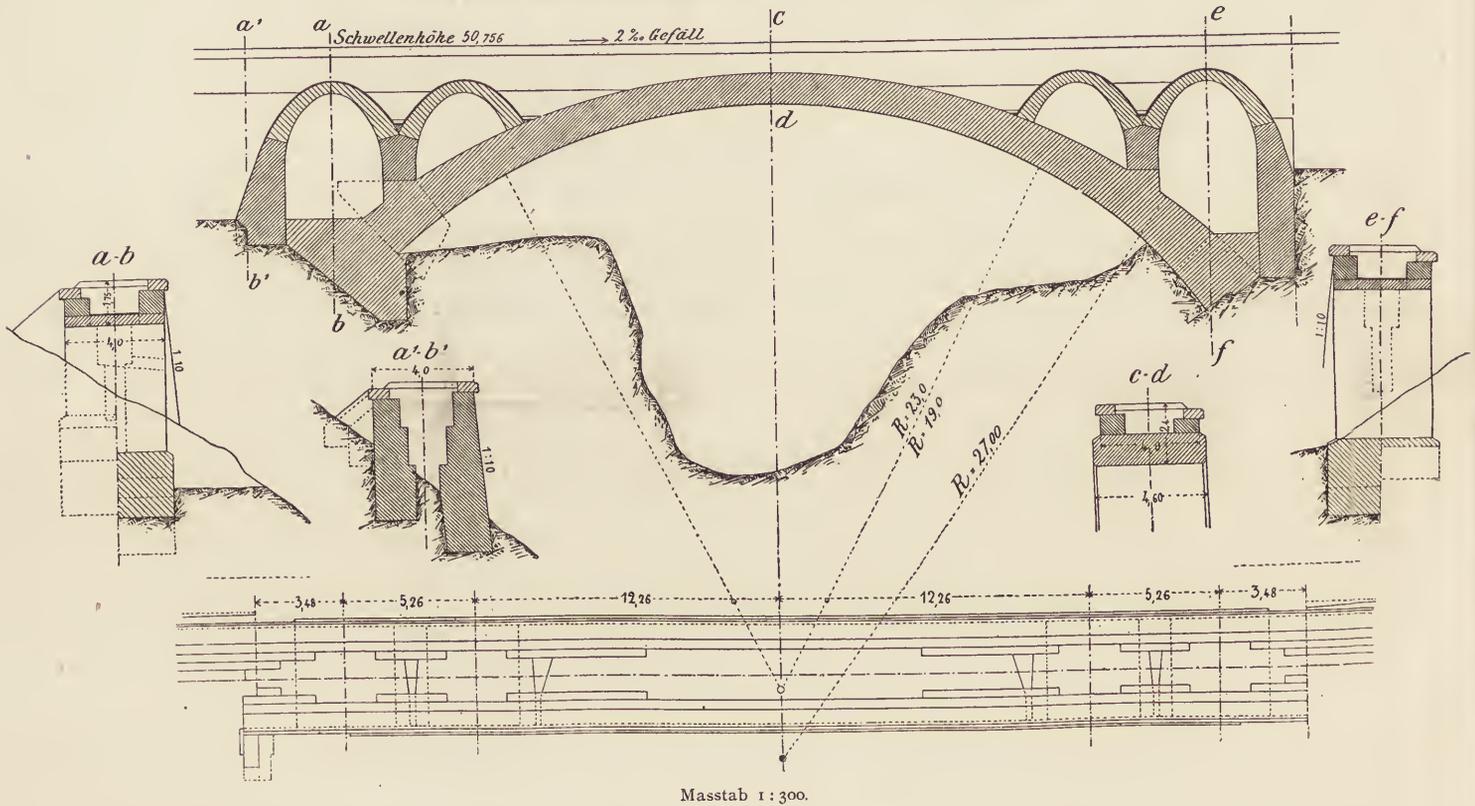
Längs-, Querschnitte und Grundriss der Betonbrücke.
